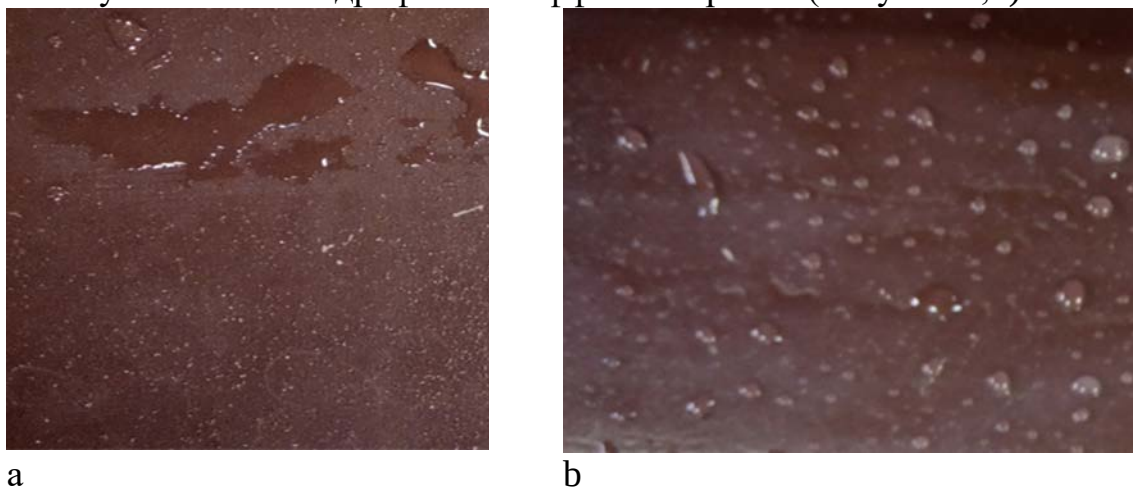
Фото покрытия на подложке из профнастила кровельного «MR-20» после увлажнения: а- контрольный состав (без добавки ГКЖ 136-41); б - с добавкой ГКЖ 136-41
